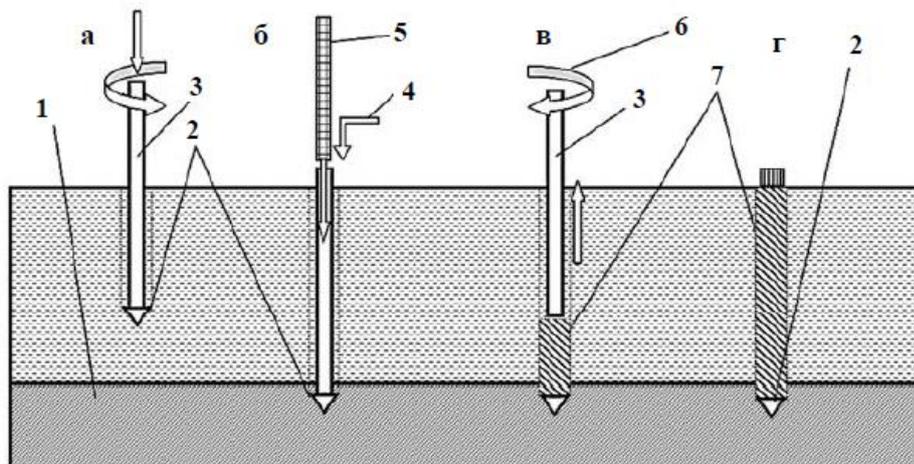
Технологічна послідовність влаштування палі: 1 – щільний ґрунт; 2 – башмак, що втрачається; 3 – обсадна труба; 4 – подавання бетону цебром або бетононасосом; 5 – арматурний каркас; 6 – напрям обертання обсадної труби; 7 – палія в ґрунті
